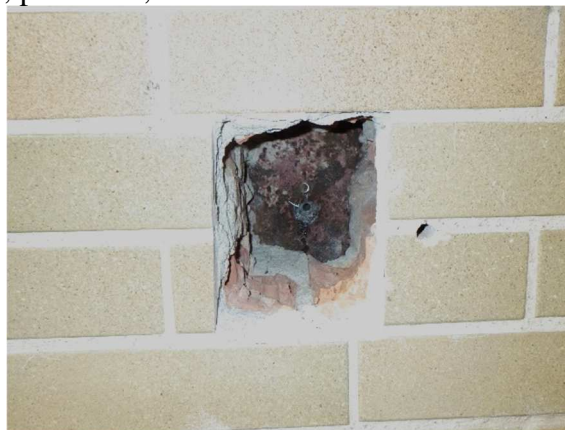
sonda NS-A1 – obnažená část, Foto č.68–sonda NS-A2 – celkový pohled;
